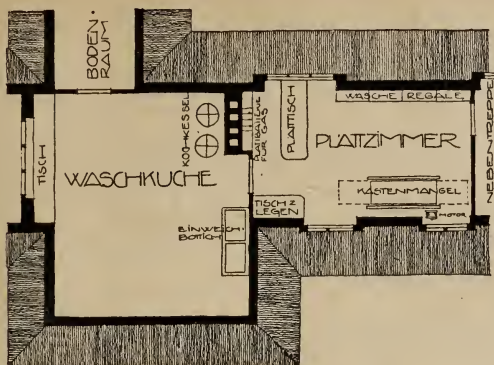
Waschküche und Plättstube für Handbetrieb im Dachgeschoß eines größeren Hauses
